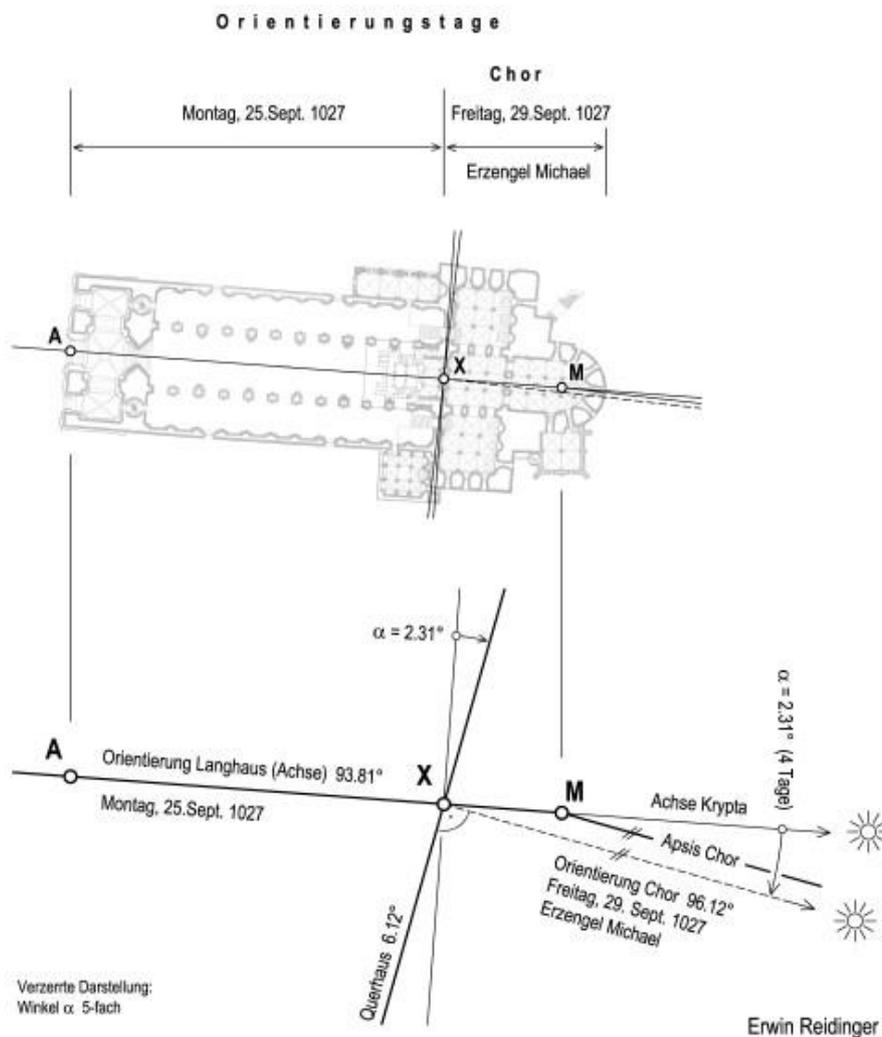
Speyerer Dom mit den im Grundriss verewigten Orientierungstagen
